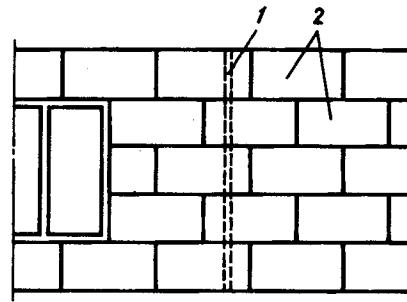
Двухслойные плиты для утепления стен с наружной стороны
